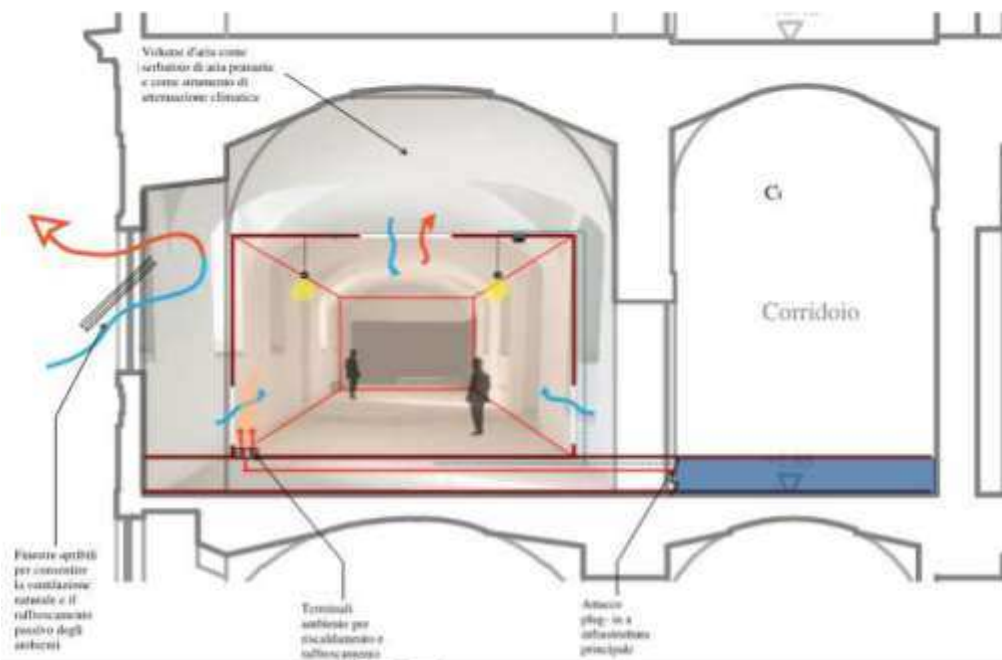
Box in box, tipo 1: Riscaldamento e raffreddamento a pavimento e ventilazione naturale
